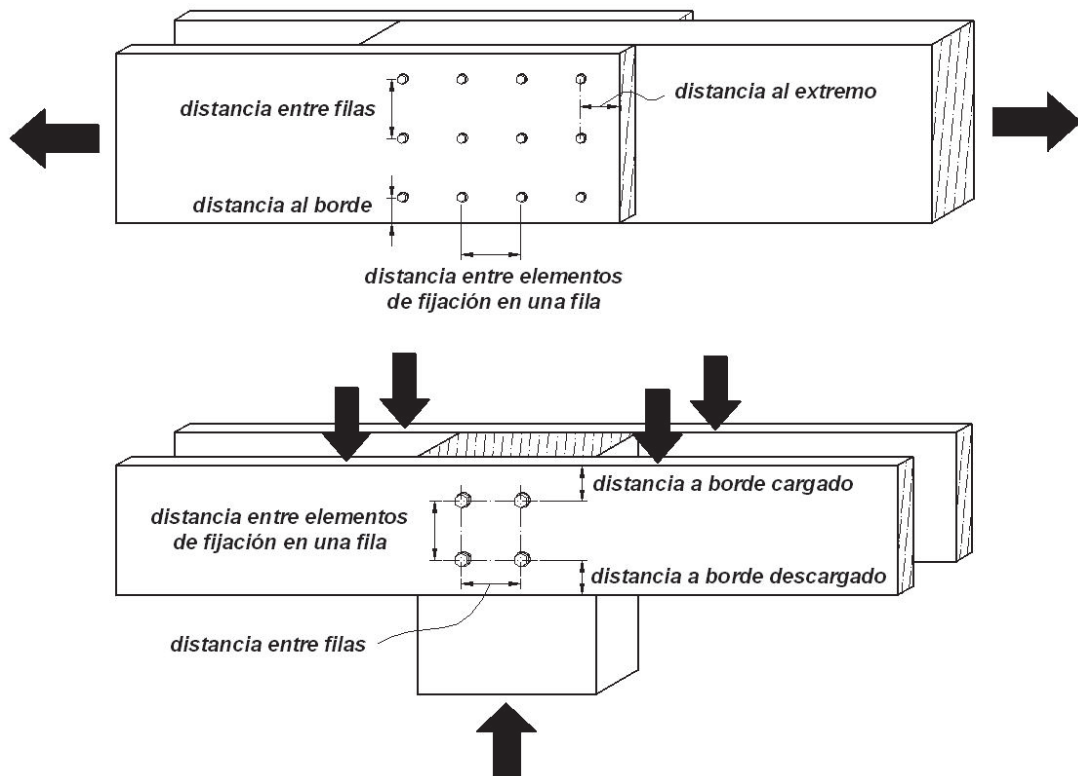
Geometría de las uniones con elementos de fijación de tipo clavija.
